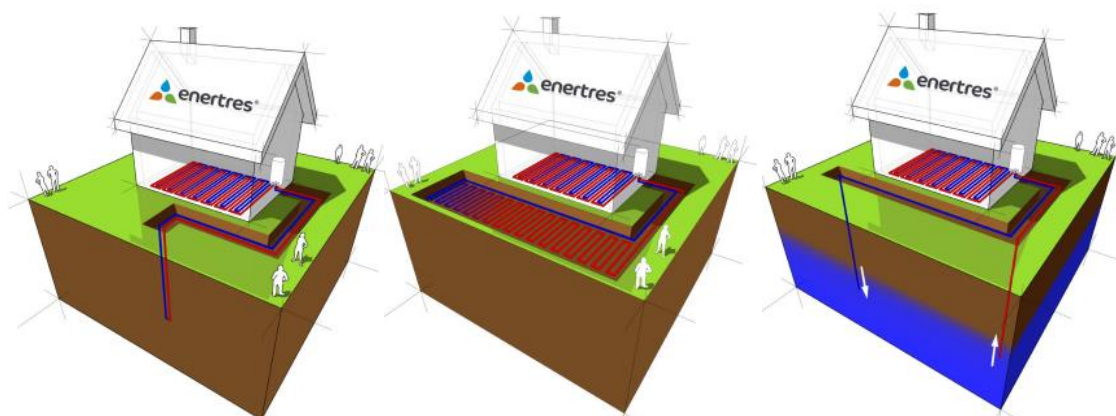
Sistemas de captación. FUENTE: Enertres. (25)
